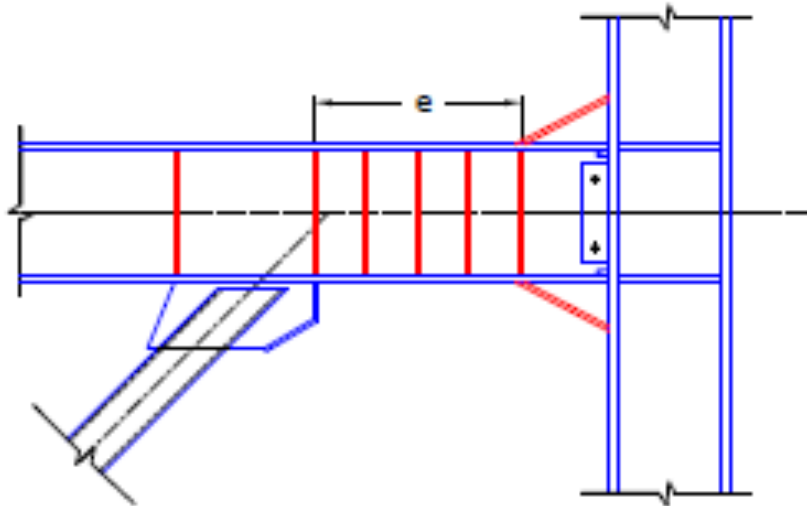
Detalle del enlace y conexión reforzada a la columna.
